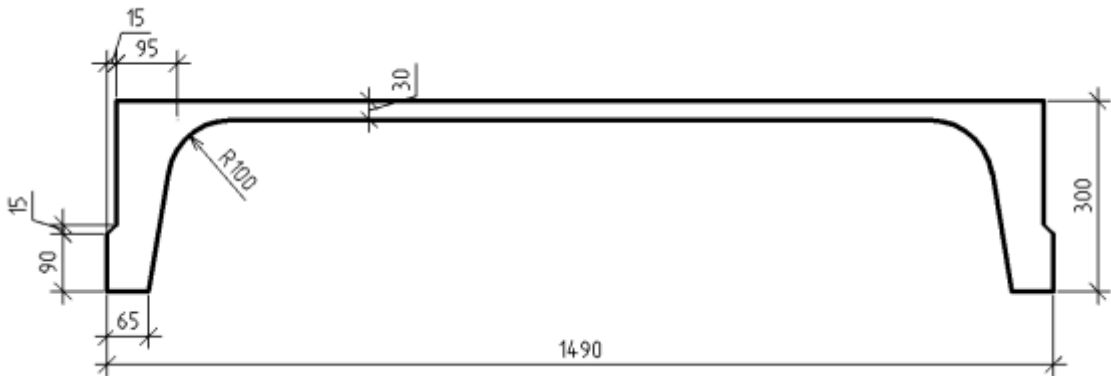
Переріз ребристої плити перекриття 2ПГ6-4АтVт
